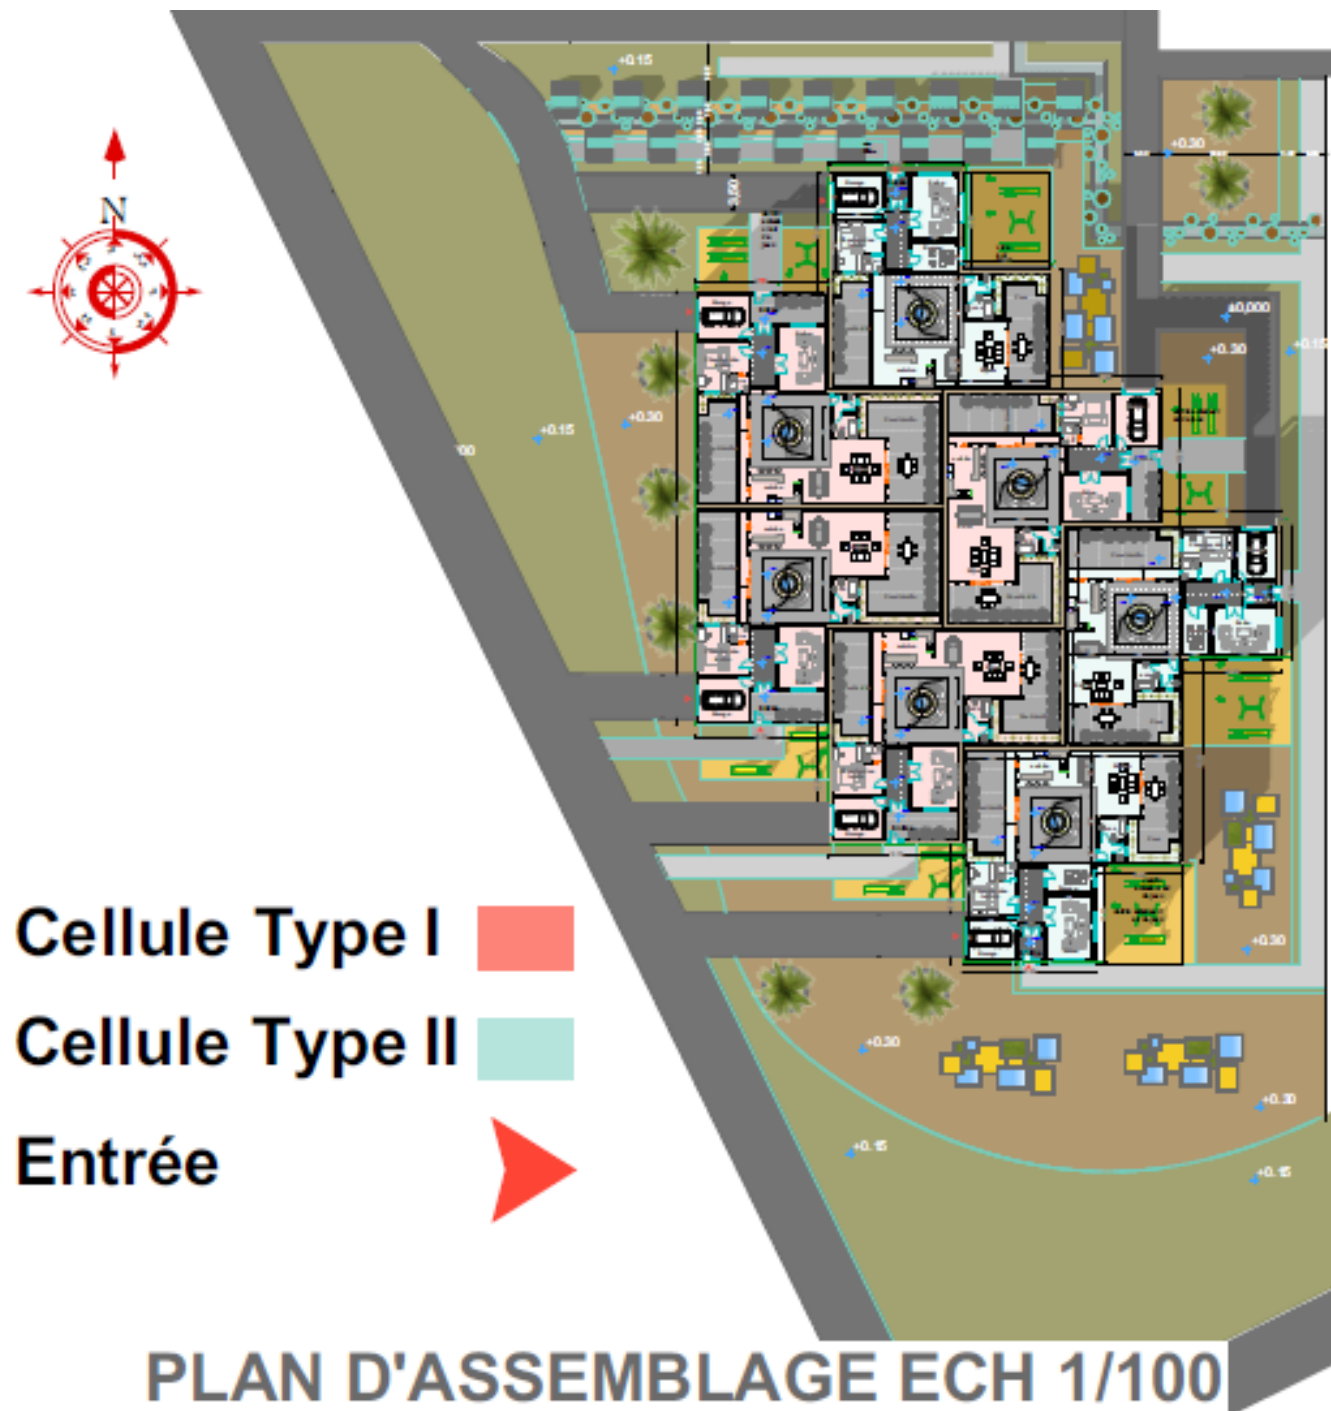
plan d'assemblage de 7 cellules à l'échelle 1/100
